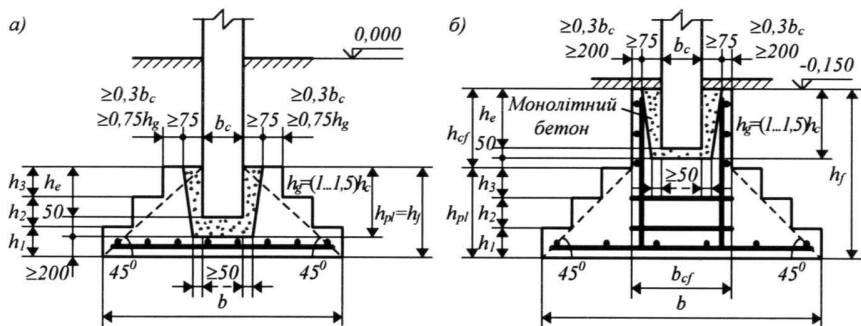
Монолітні залізобетонні фундаменти стаканного типу:
